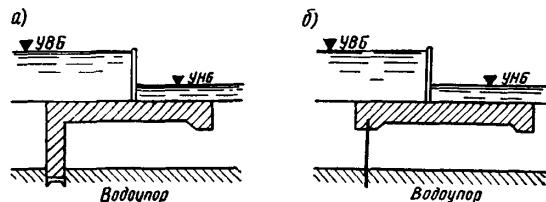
Водопроницаемое основание до водоупора пересекается:
